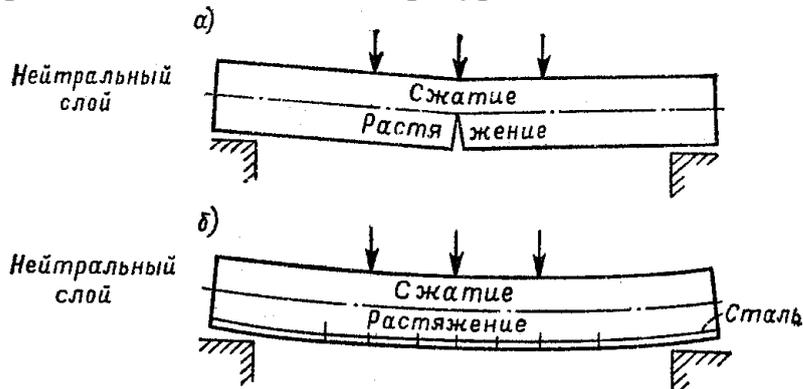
Бетонная и железобетонная балки под нагрузкой.
